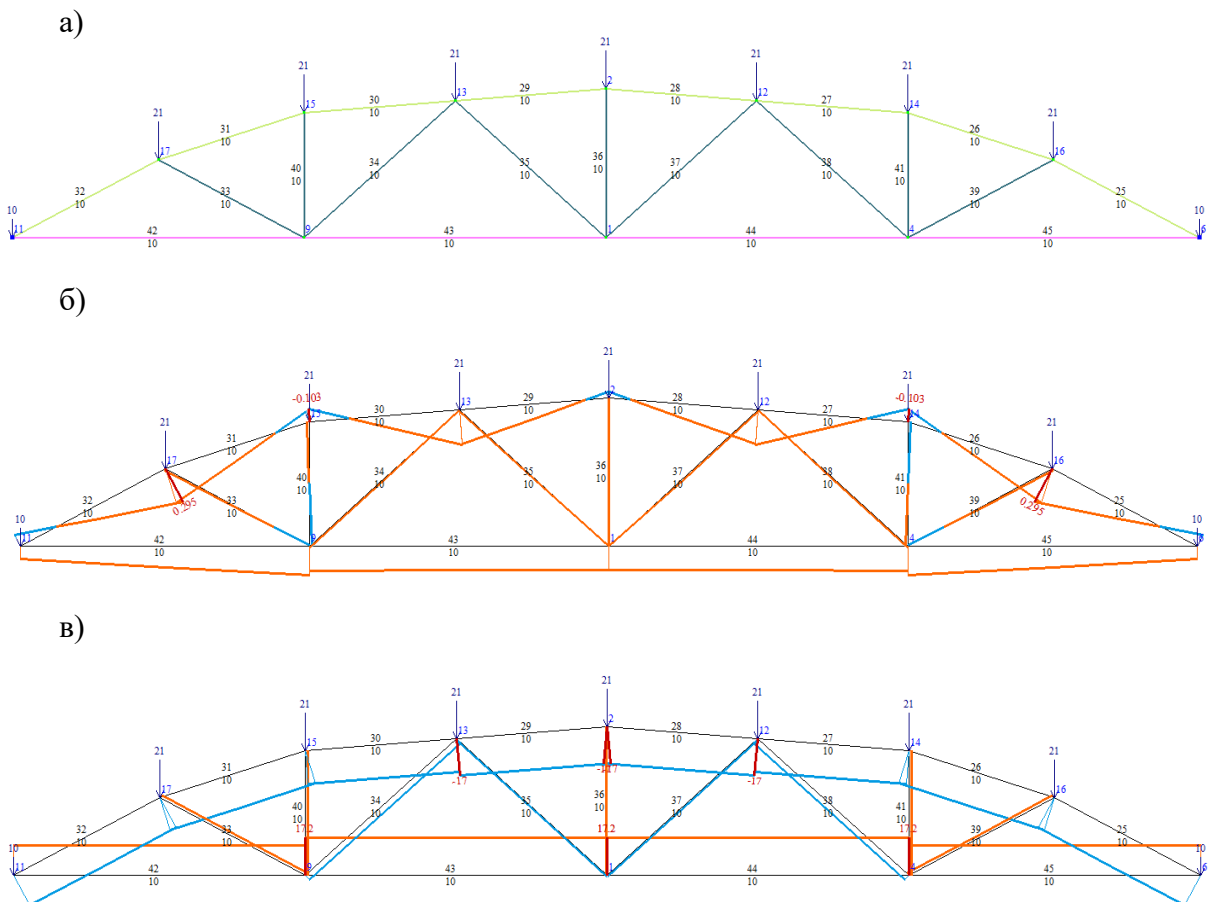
а) Розрахункова схема навантаження від снігового навантаження;
